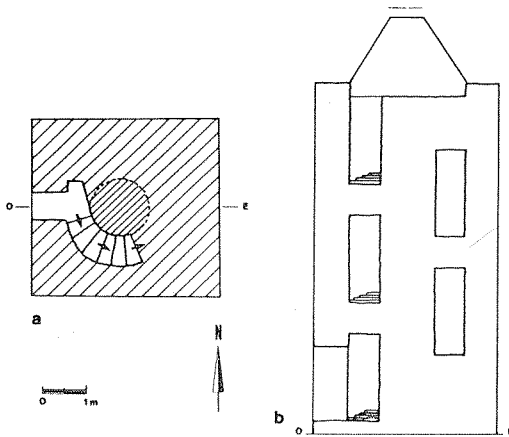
Alminar de la mezquita de Velefique: a) planta en la base; b) sección Este-Oeste.
